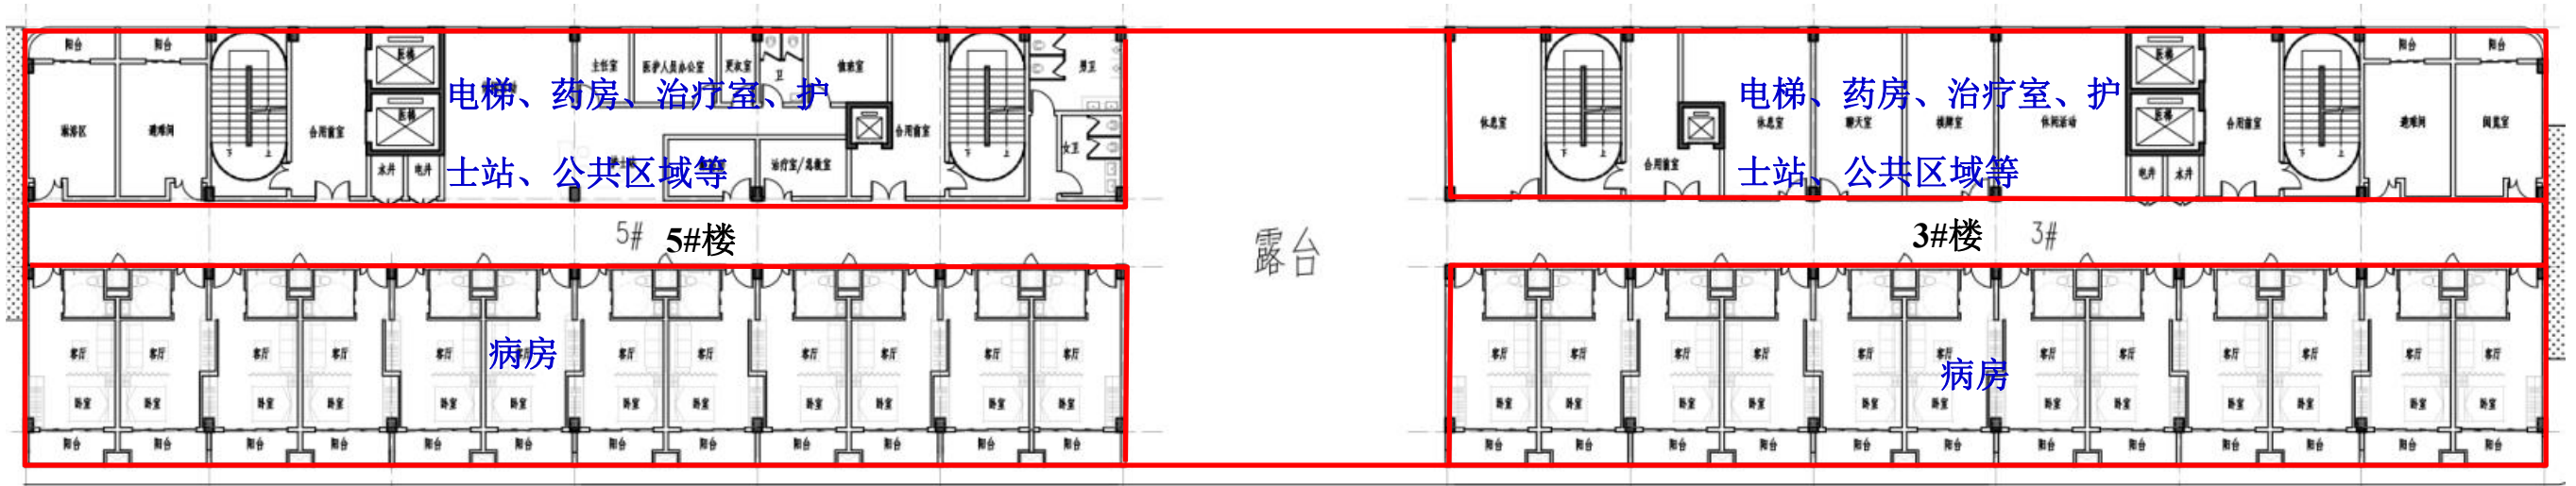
3#、5# 介助楼三~十层平面图（其中 5# 介助楼十一、十二楼与三~十层平面图相同）
